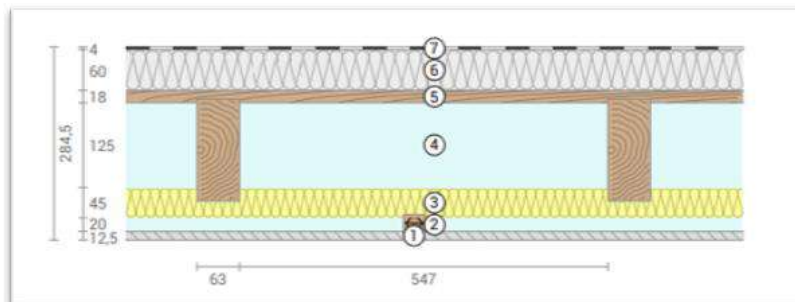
P02 Plat dak met ALU Seal 45 tussen de balkconstructie
